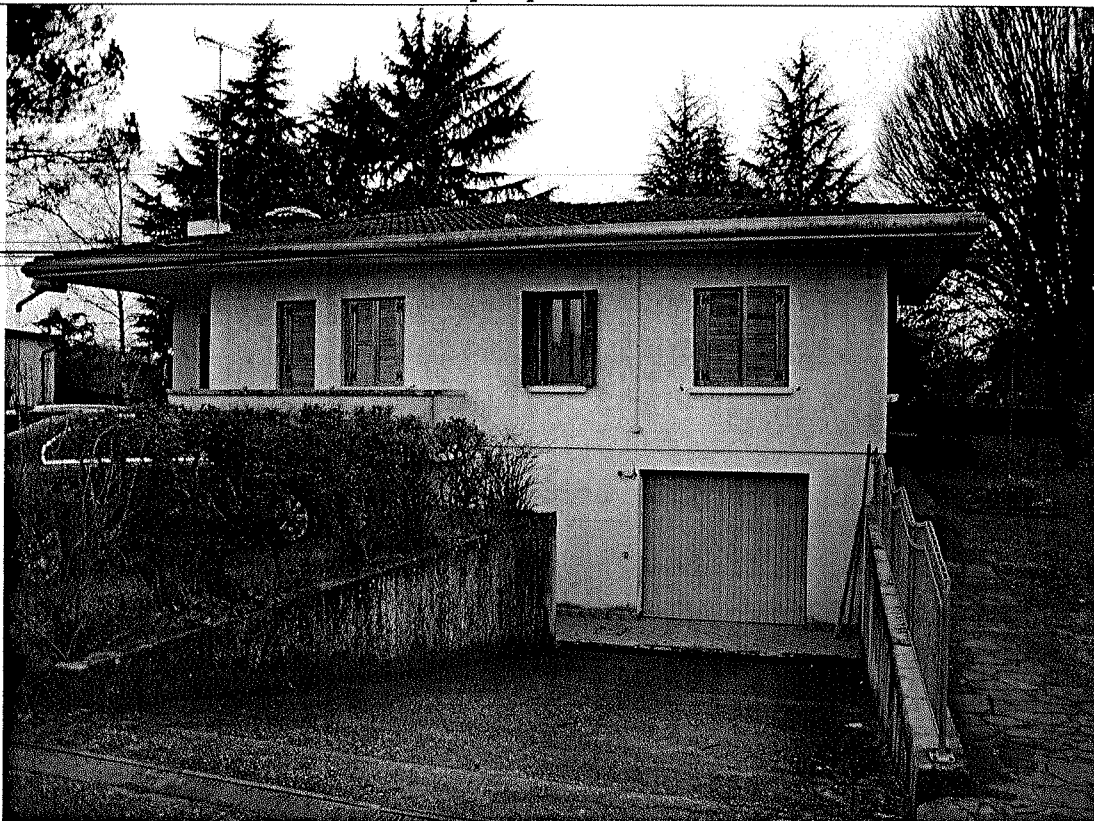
vista del prospetto sud-est dell'abitazione
